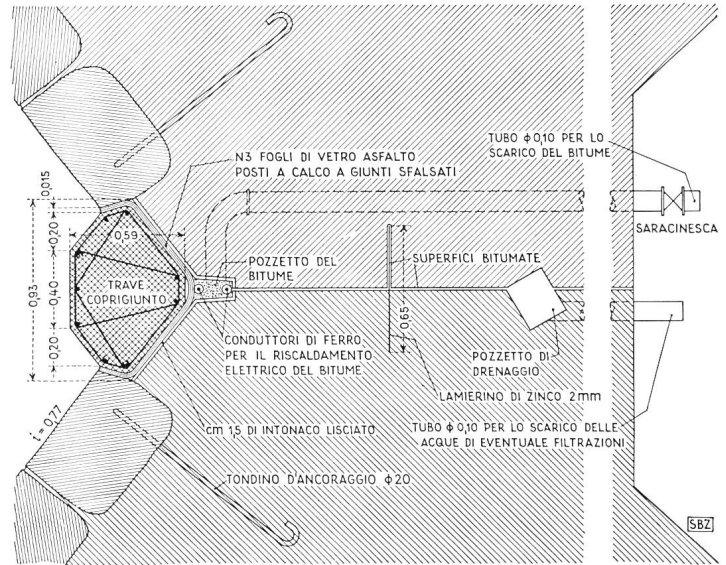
Pfeilerstaumauer Pantano d'Avio, Detail der Fugenabdichtung, Maßstab 1 : 40
